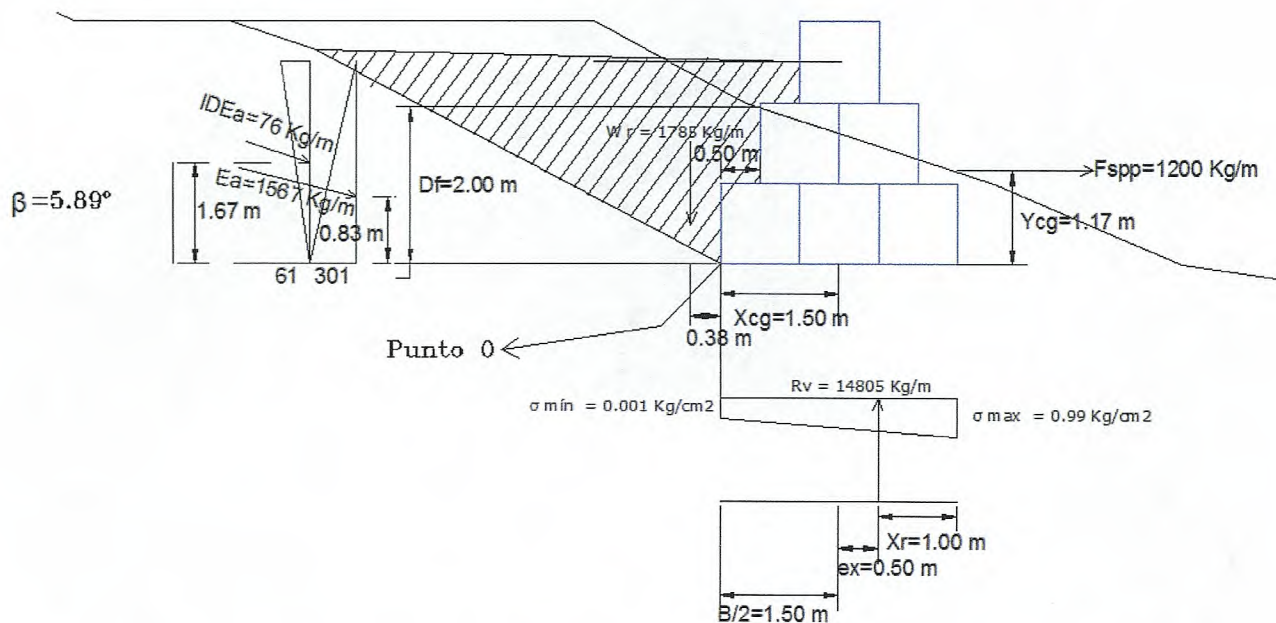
SECCION 1, Esquema de Esfuerzos Caso 2 Empuje de Tierra + Sismo
